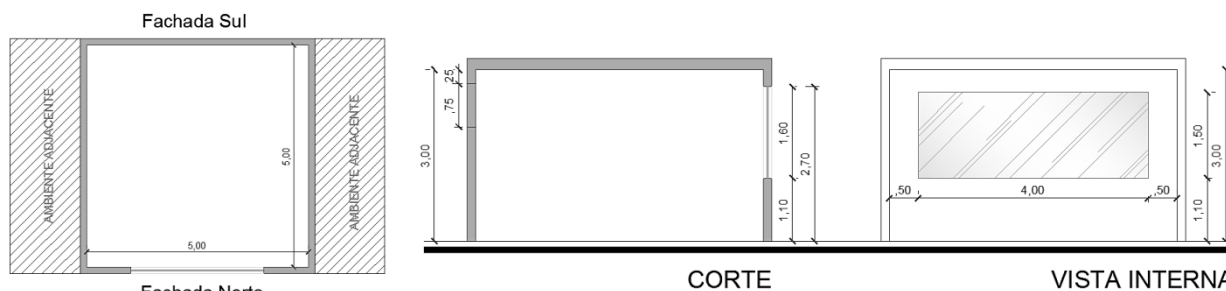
Planta Baixa do ambiente analisado e Corte (PAF 40%).
